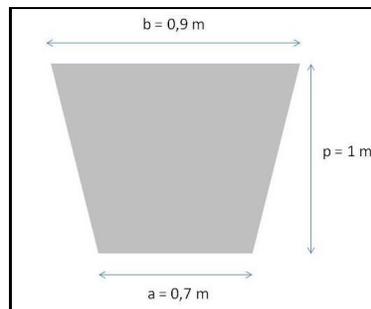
Dimensões da calha onde será instalado o biodigestor
